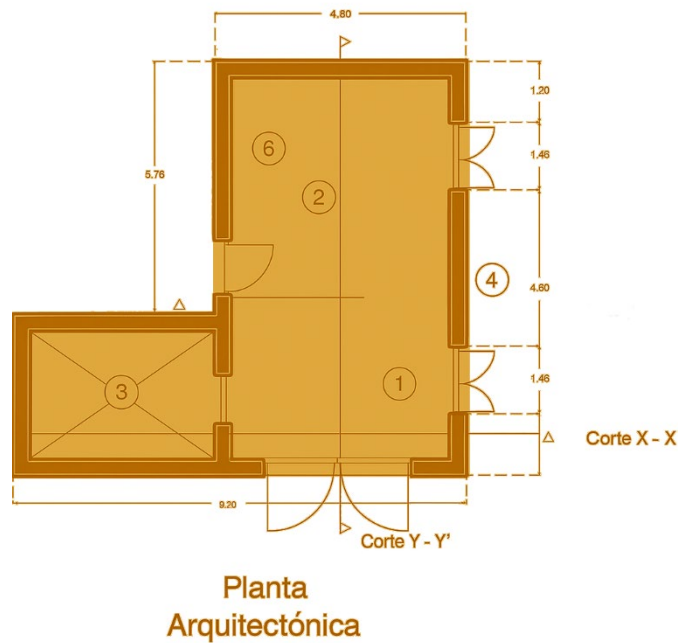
Planta arquitectónica, realizada por Hernández, 2018.
